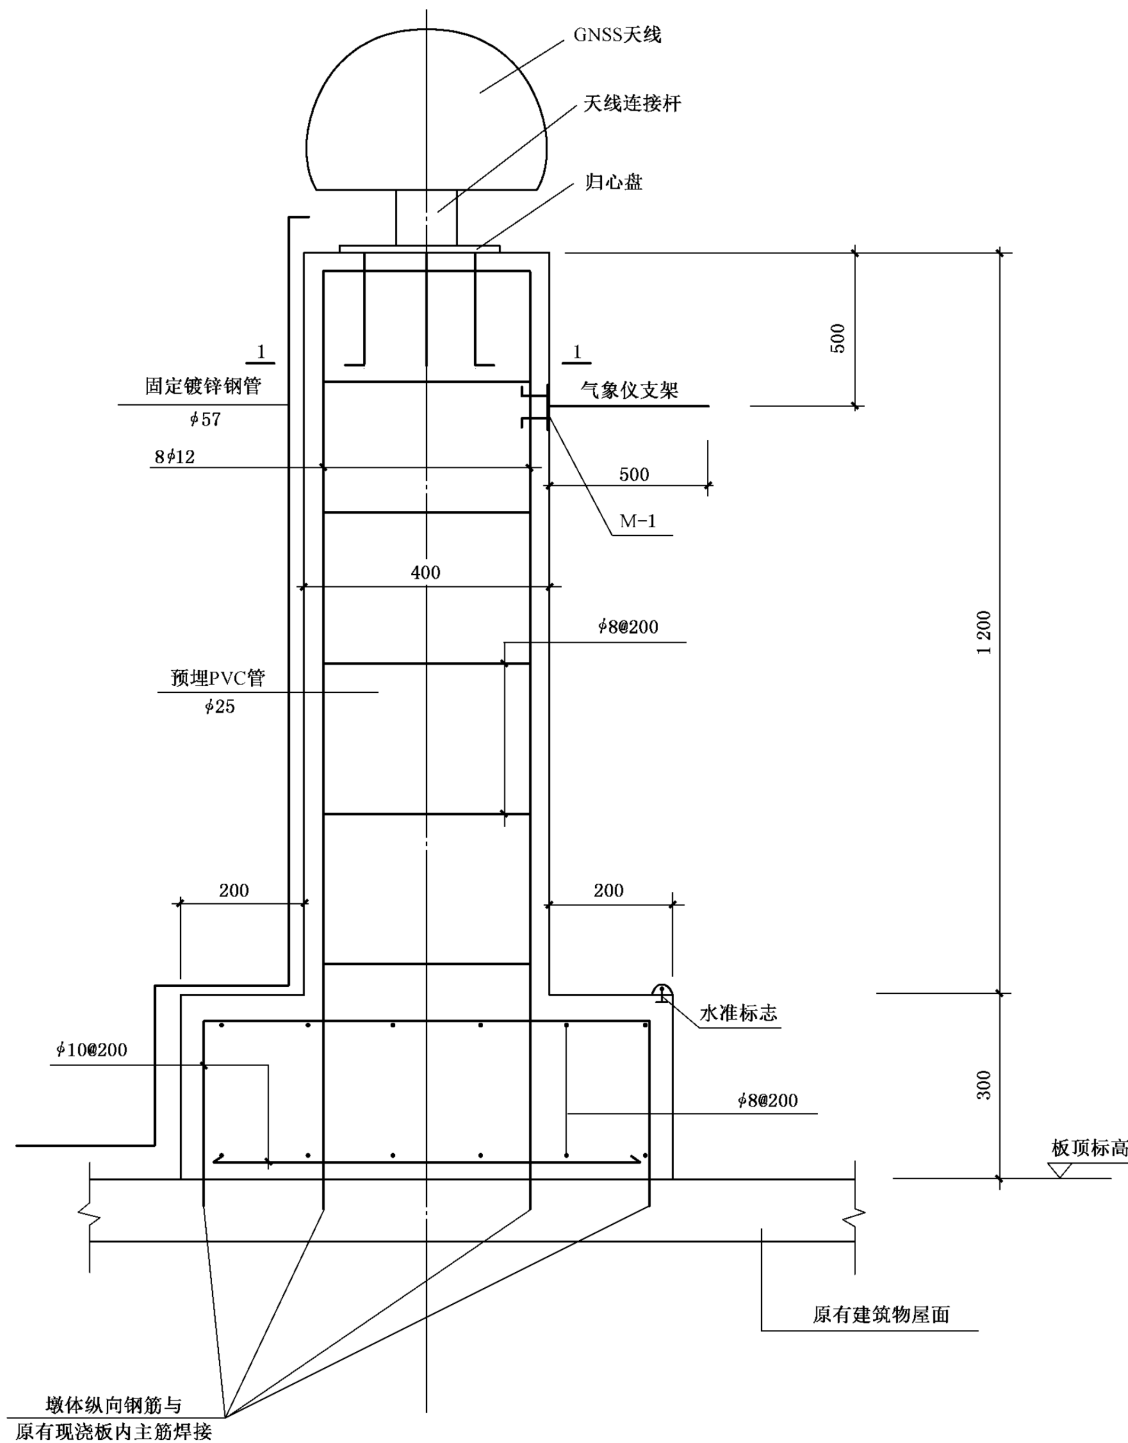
屋顶混凝土观测墩设计立面图(示例)
